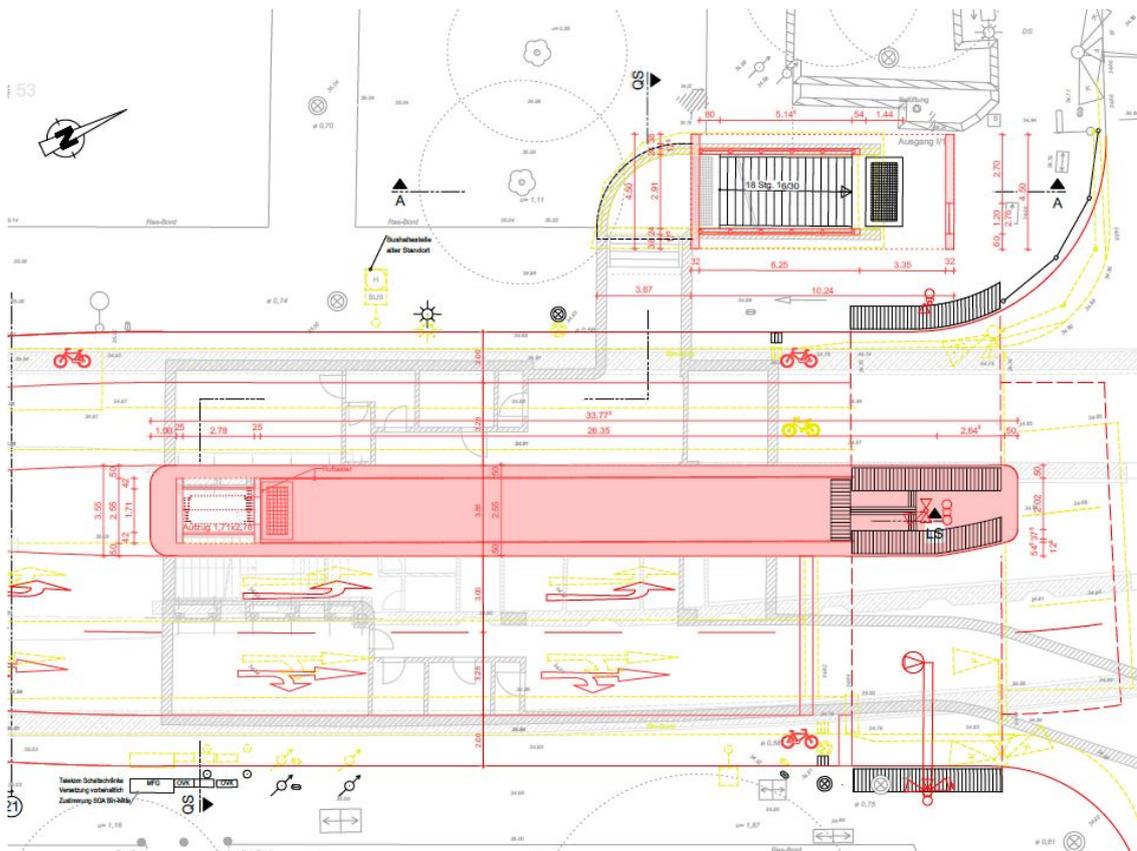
Vorzugsvariante, Ausschnitt Plan He_PG003
